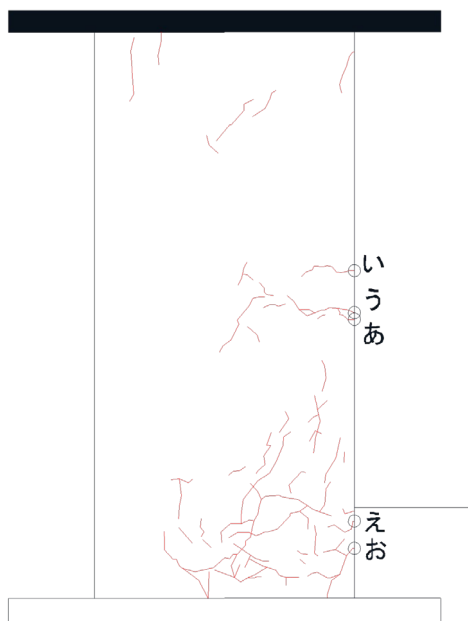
柱ひび割れ幅測定位置 (試験体 D-1 負荷荷)
